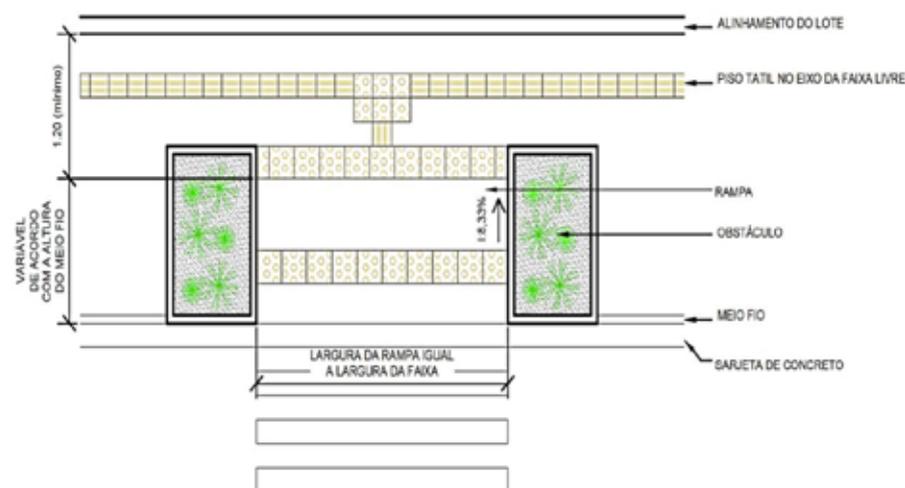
Planta baixa de rebaixo de calçada padrão (rampa transversal com abas)
